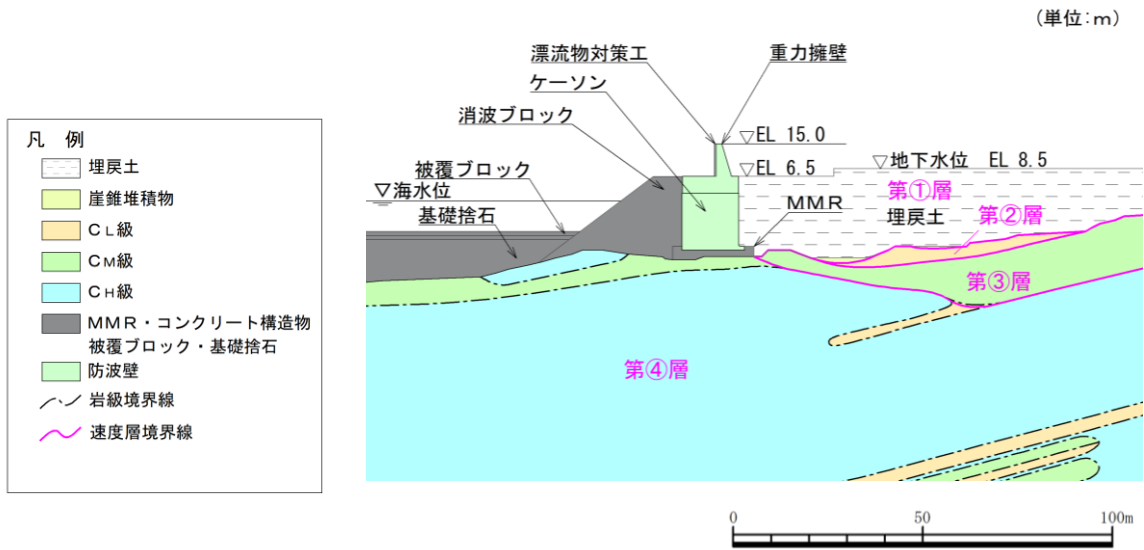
防波壁（波返重力擁壁）の横断面図（①-①断面）
